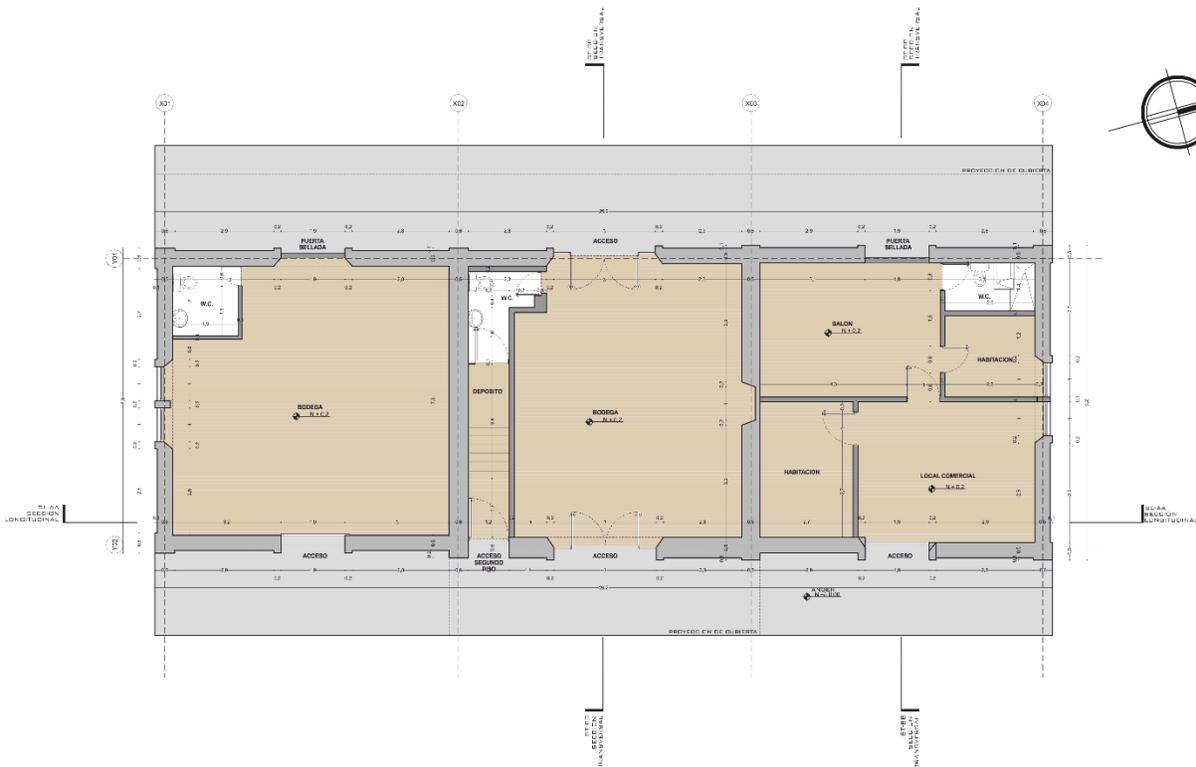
Planta arquitectónica primer nivel, Estación del ferrocarril Sur.
